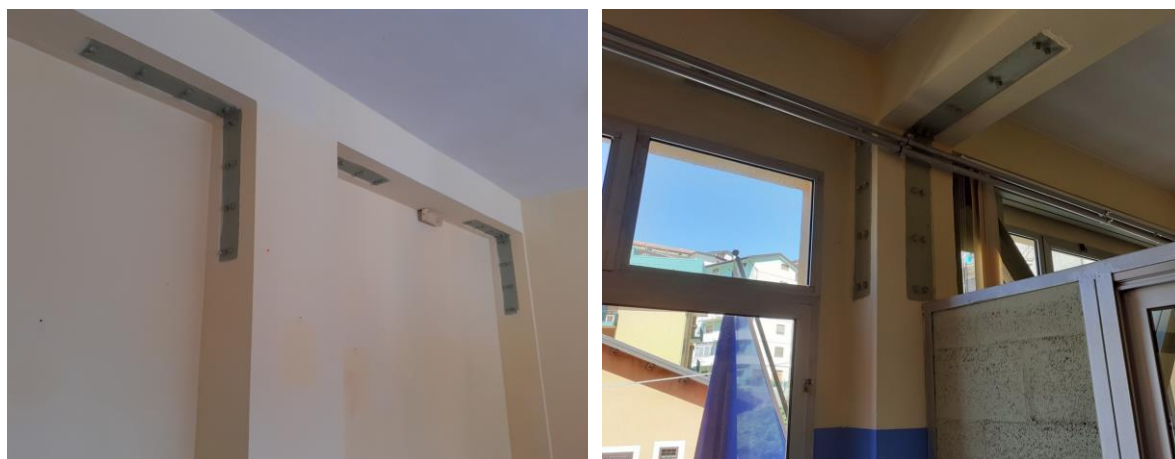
RINFORZO DI TRAVI E PILASTRI ALLE ESTREMITÀ MEDIANTE PIASTRA METALLICA
